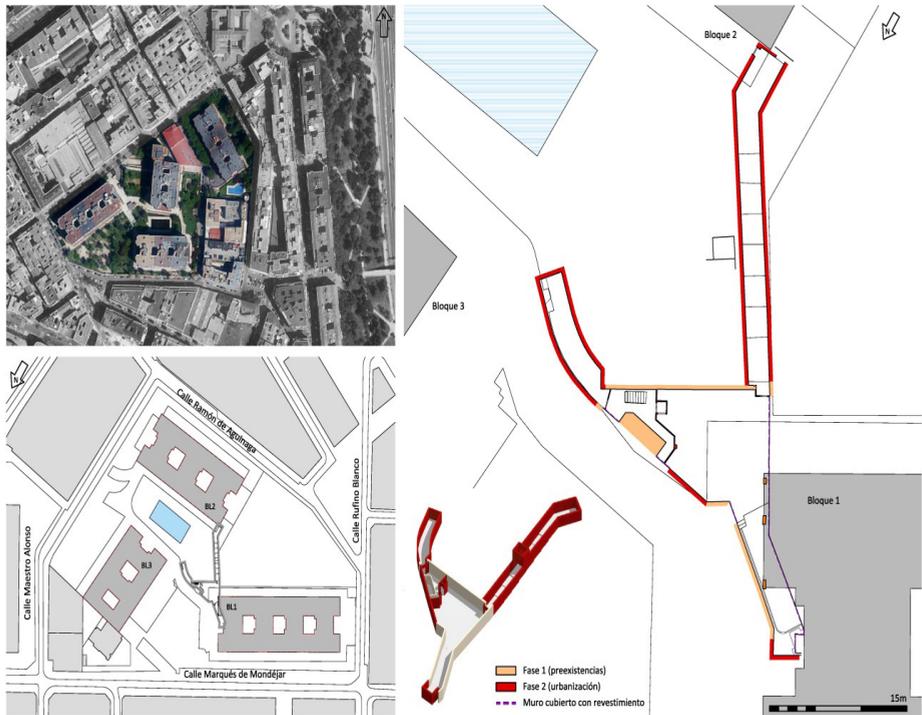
Planta de las galerías subterráneas superpuesta sobre la planta de la urbanización. (Imagen de los autores).
